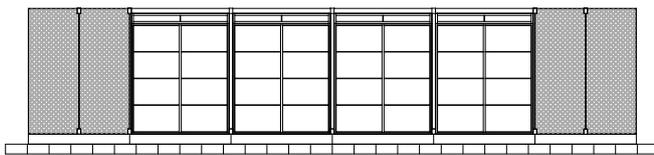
Alçado Sul - Vão completo - caixilharia 1/150
